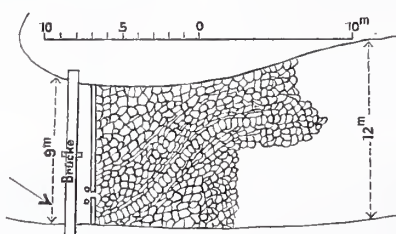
Grundriss des Wehres mit Lachsweg.
